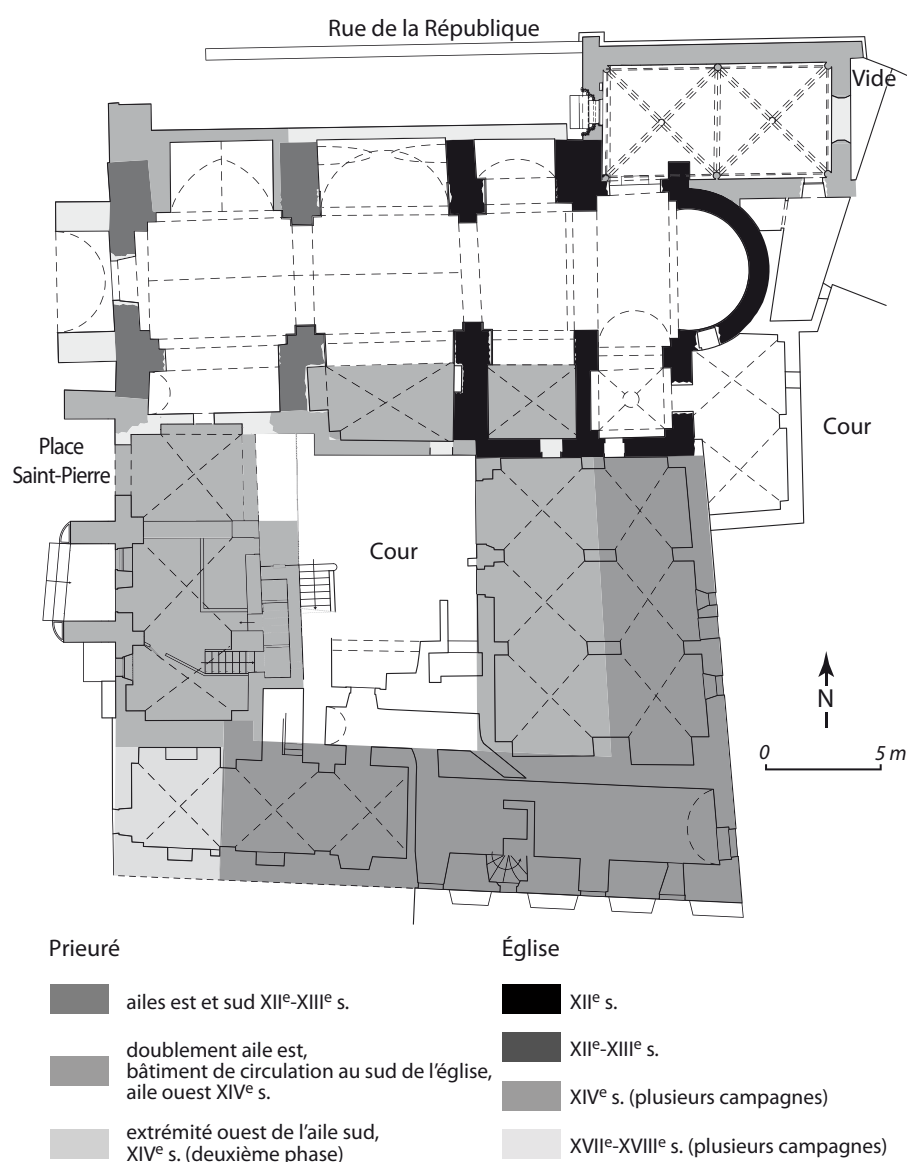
GOULT, prieuré Saint-Pierre. Plan général du site et chronologie, calage de trois plans distincts (Fr. Guyonnet et N. Duverger / SADV) :
